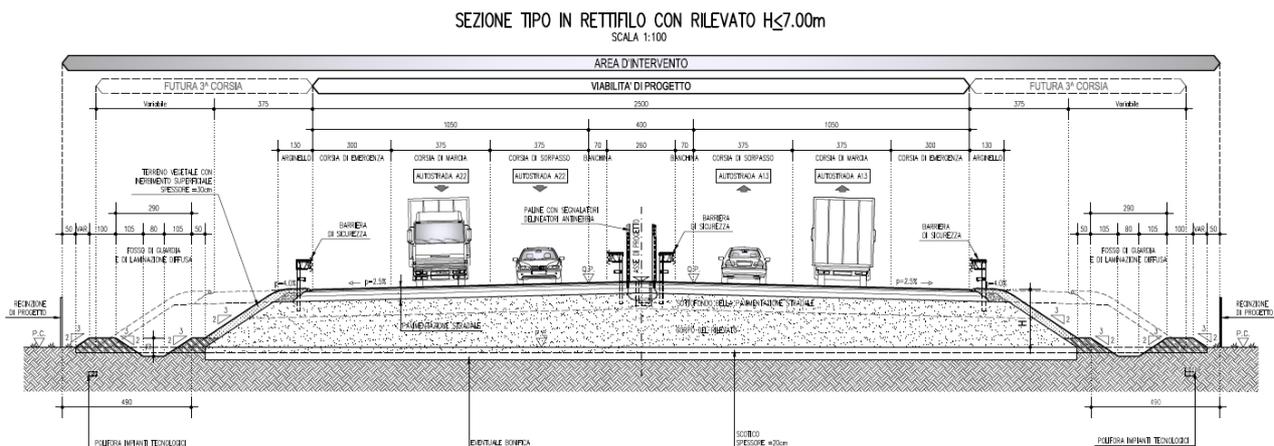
SEZIONE TIPO ASSE AUTOSTRADALE IN RETTIFILLO (RILEVATI < 7M)
